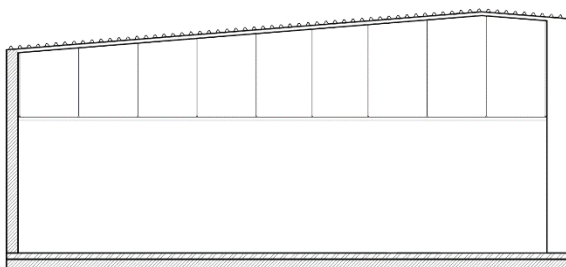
Teto original do espaço e aplicação de tetos falsos em corte do armazém a
